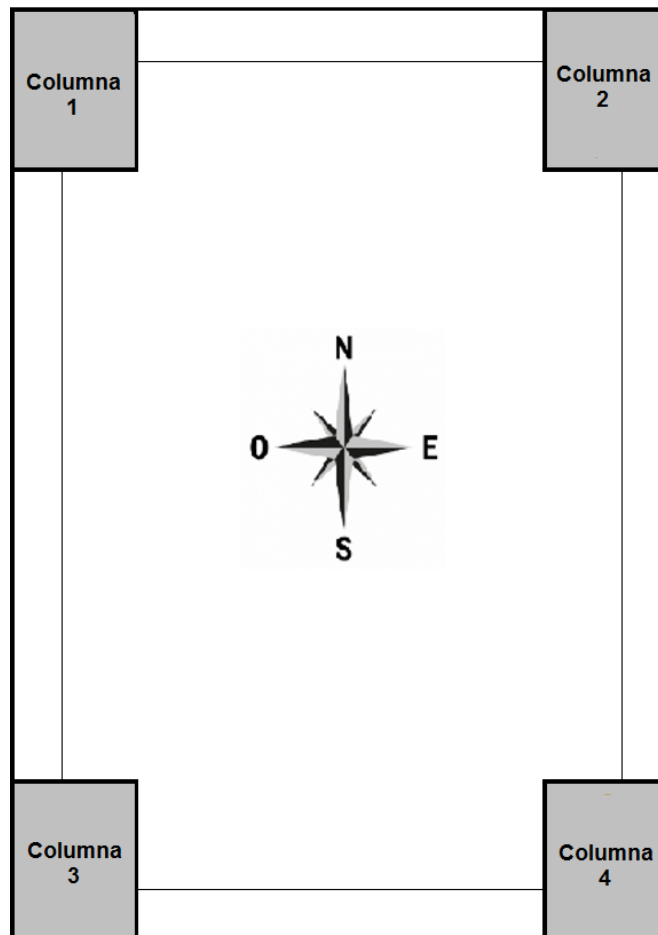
Vista de planta del techo Esquema básico del local intervenido.
